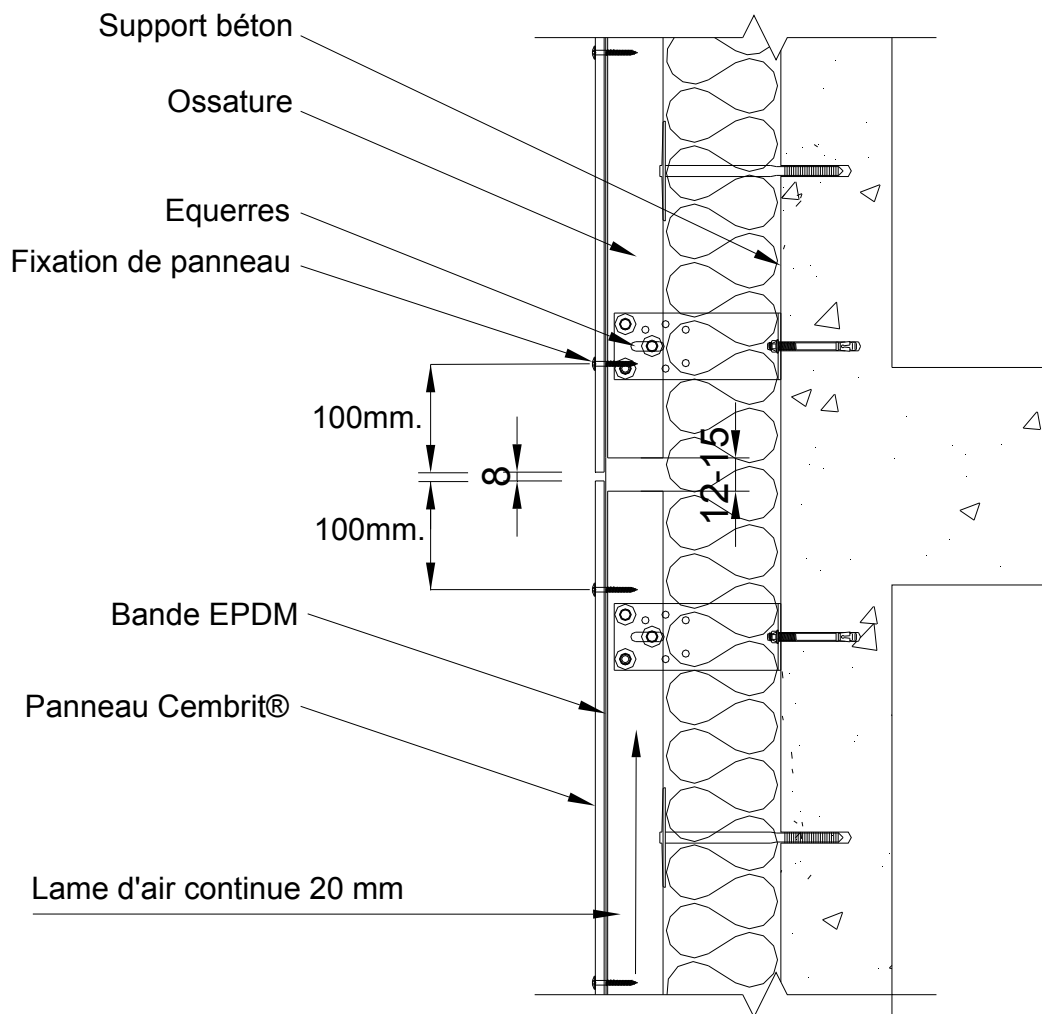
Joint de fractionnement au droit de chaque plancher - Coupe verticale
